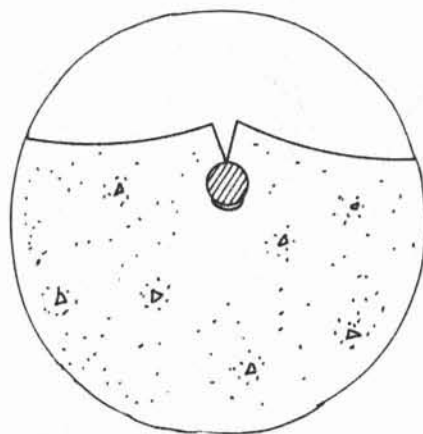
Detalhe da fissura ao longo da armadura (CEB<sup>21</sup>)
